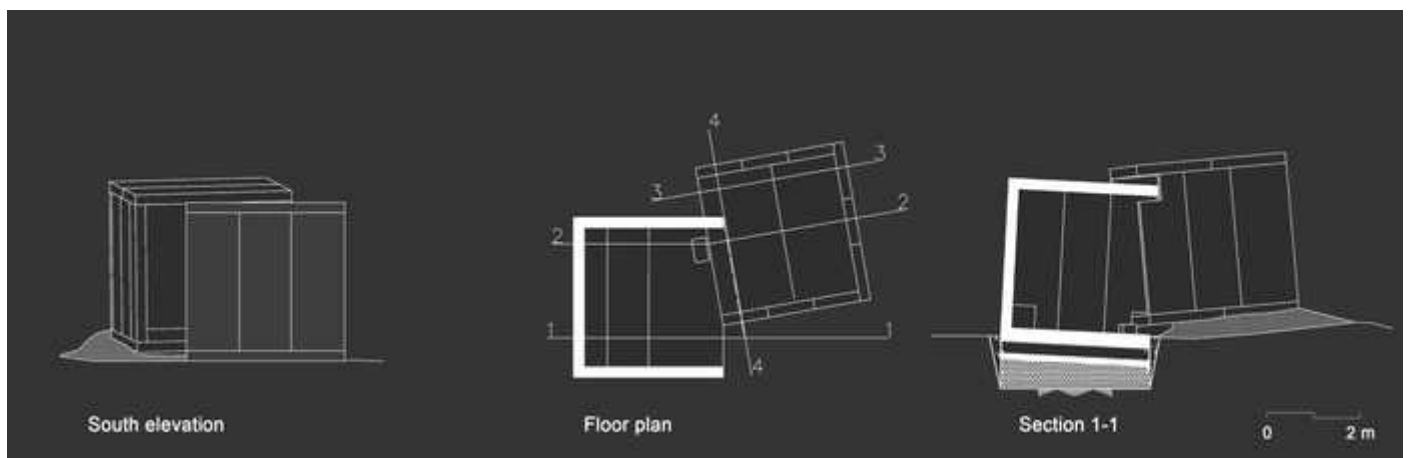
Alzado y secciones de los cubículos encajados orgánicamente. Este espacio está construido con piezas de granito despiezadas en los planos, sin necesidad de aportar más elementos.
